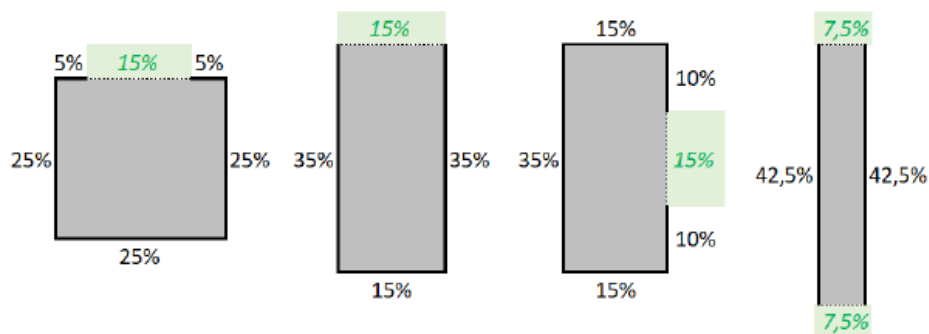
Ejemplos de localización y dimensiones mínimas (en porcentaje) de las fachadas accesibles en edificios de planta cuadrada y rectangular
